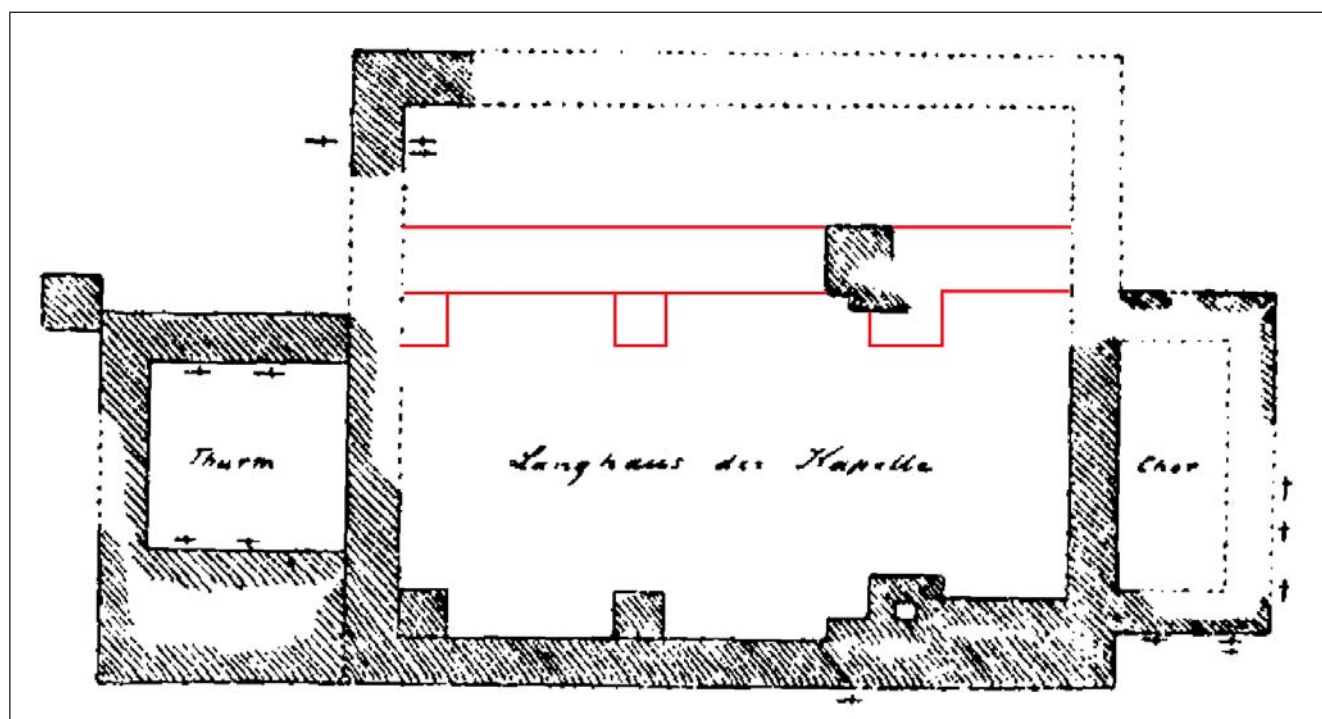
Alt-Schieder. Grundriss der Kirche (nach v. OPPERMANNSCHUCHARDT 1888-1916). Rote Linien: möglicher Fundamentverlauf vor der Erweiterung nach Norden. M. 1:200.
